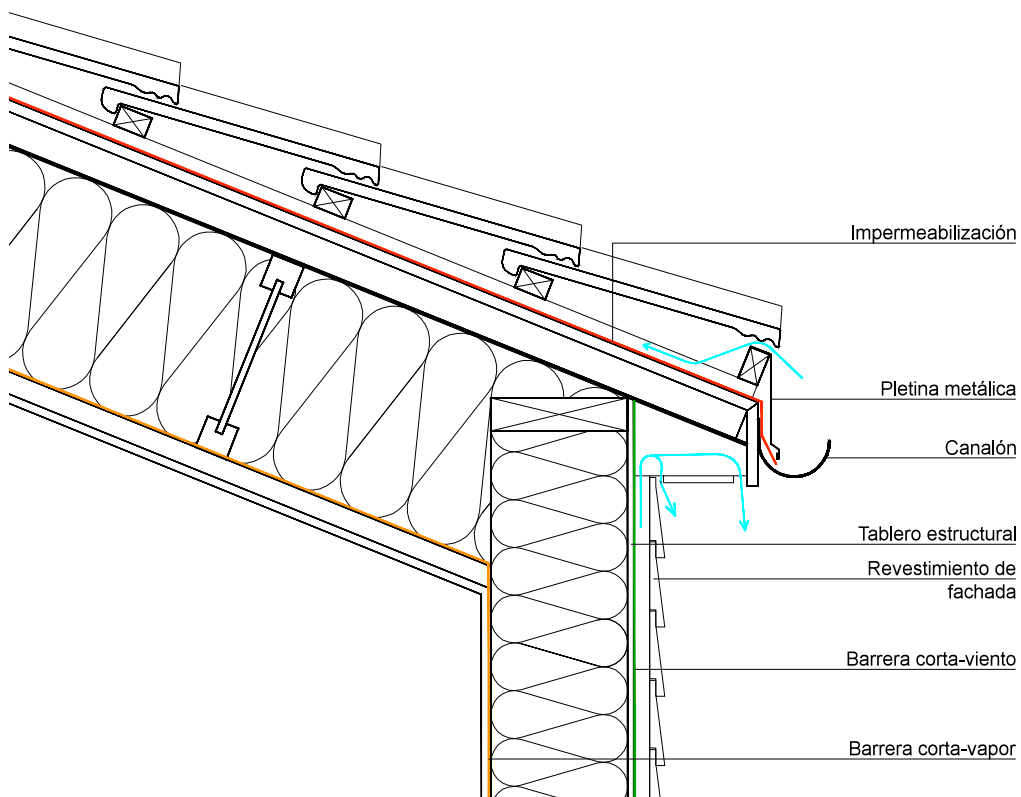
Encuentro entre el muro y la cubierta (caso cubierta a dos aguas).
